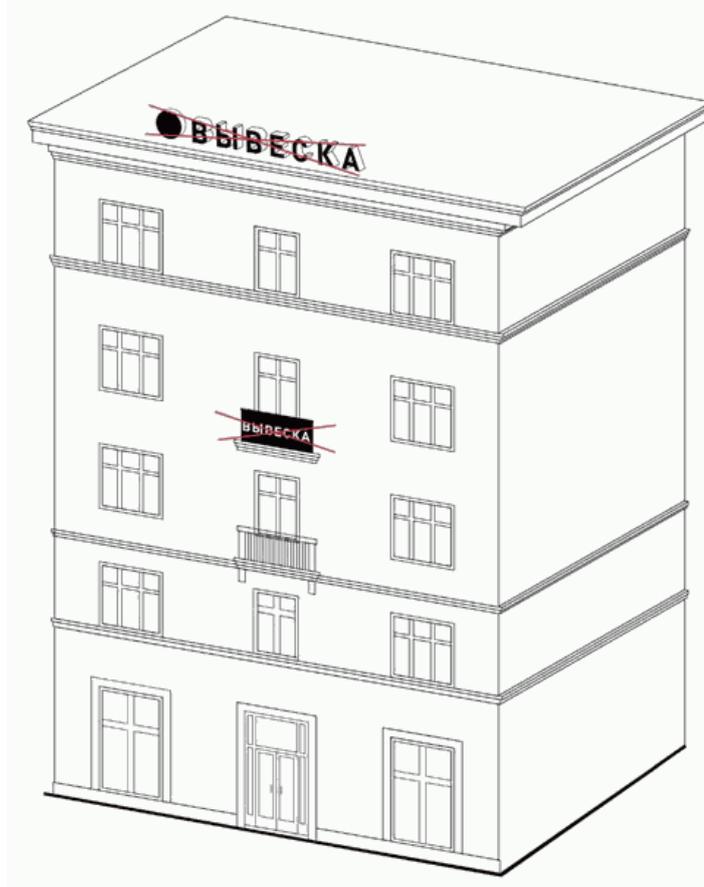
Размещение информационных конструкций на архитектурных деталях фасадов.
